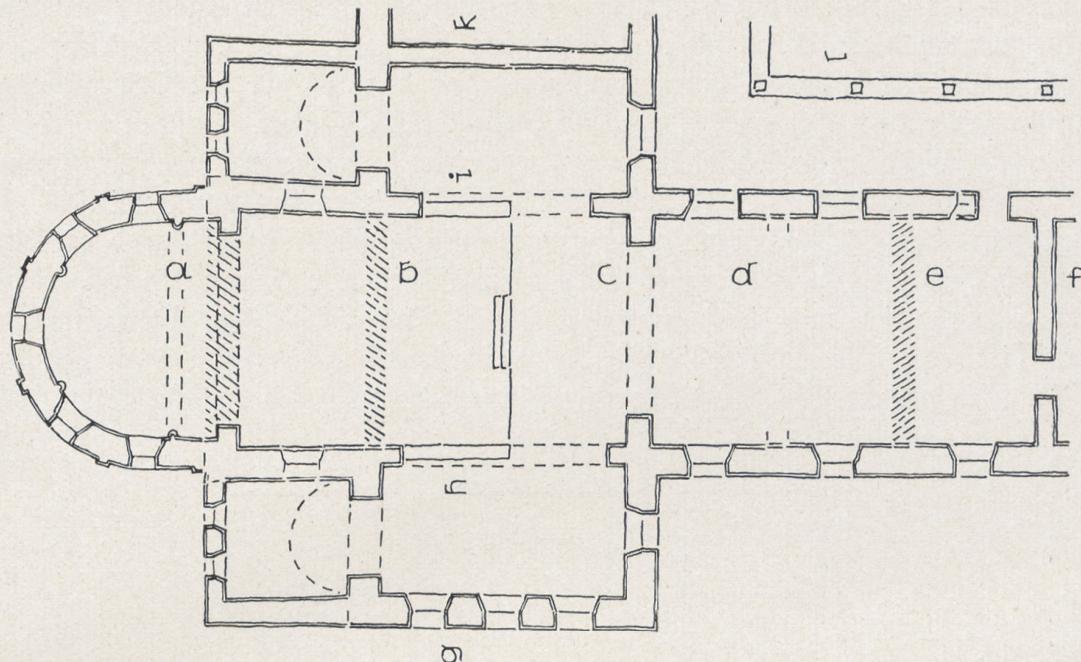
Dritte und vierte Kirchenperiode, Grundriss 1:300.
